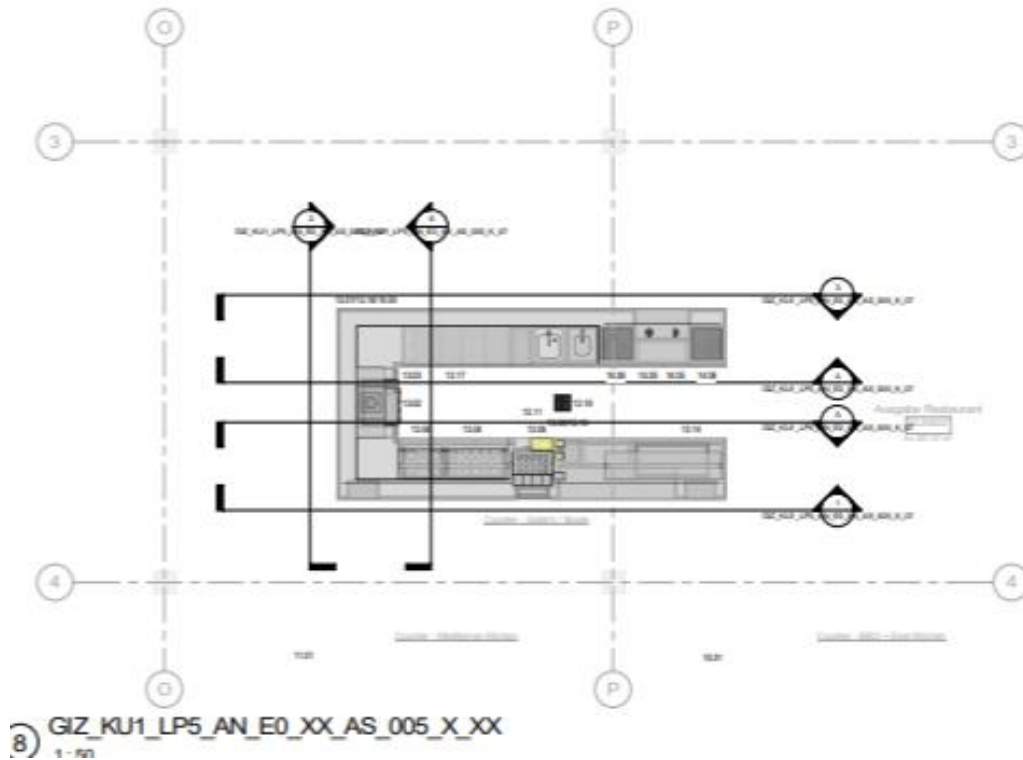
Grundriss-Auszug Salatbar – Position der Kassenstation 5
